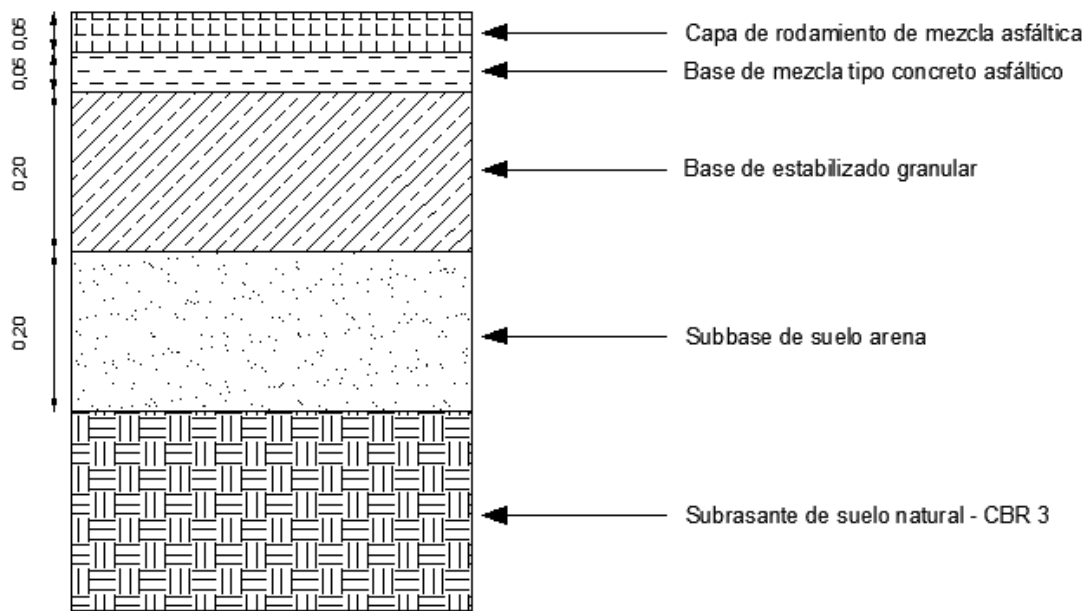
Propuesta paquete estructural (Fuente: Elaboración propia)
